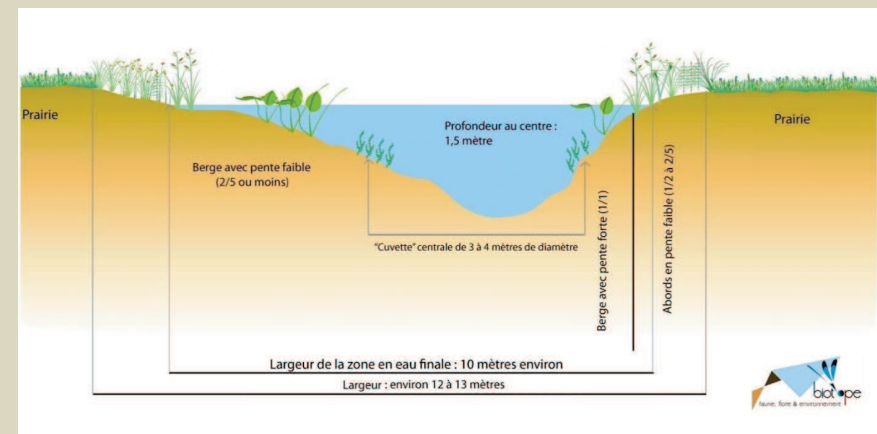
Coupe transversale d'une mare favorable aux amphibiens
